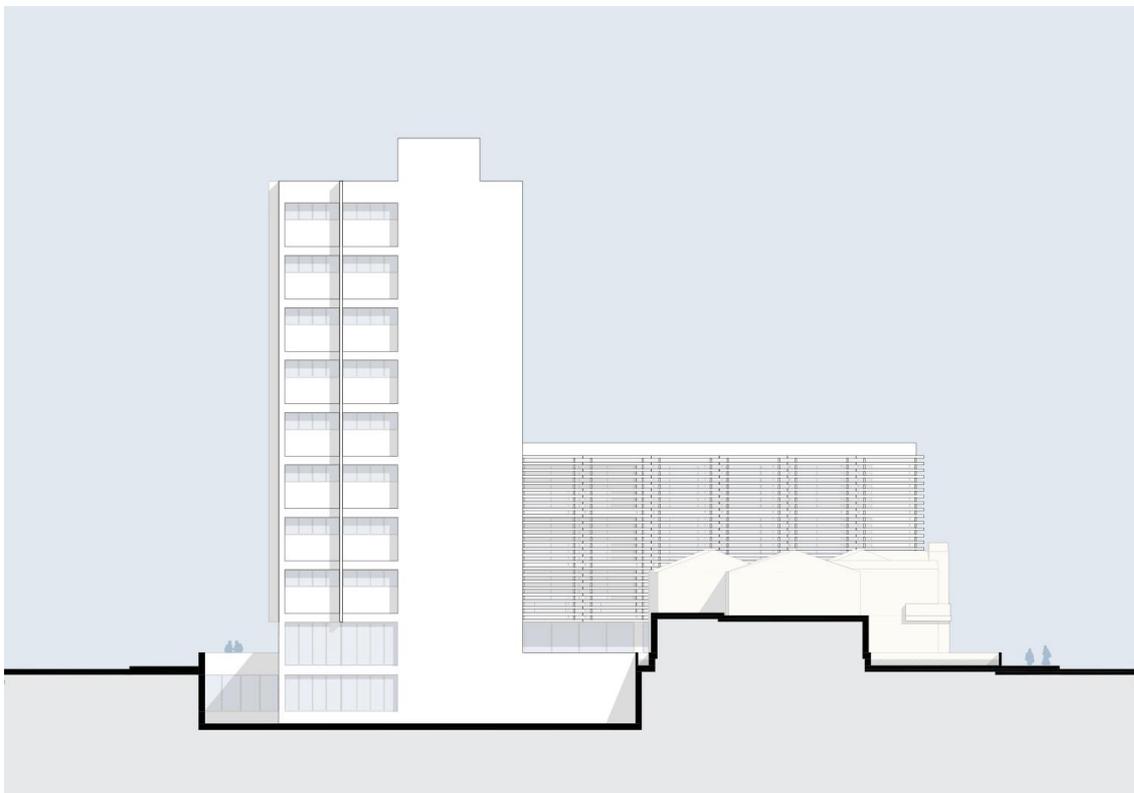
Fachada desde calle Leonidas Pl. Gutierrez. Elaboración propia
